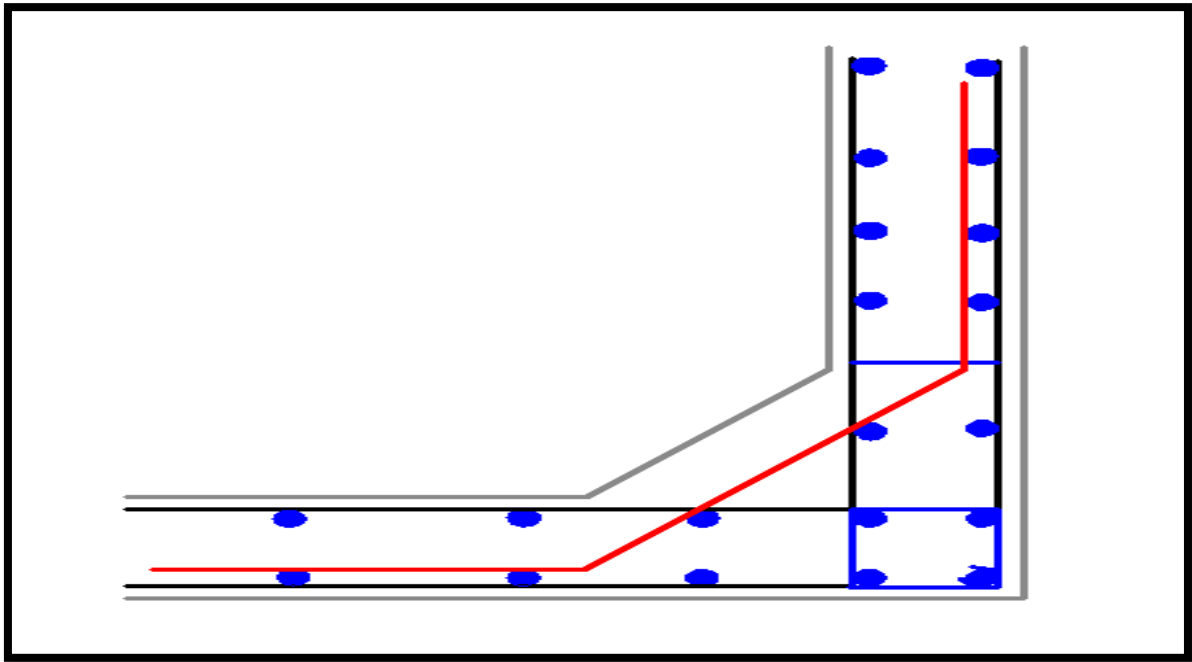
Ferrailage du gousset inférieur (radier-piédroits)
